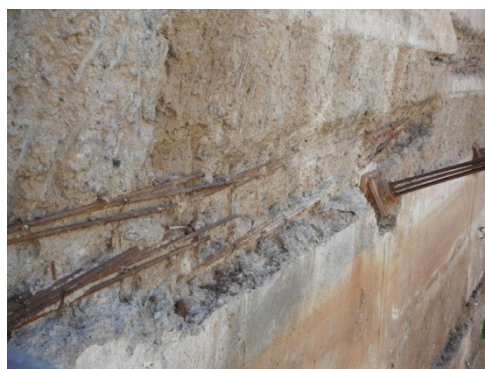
Armaduras de espera da laje nas paredes de contenção lateral
